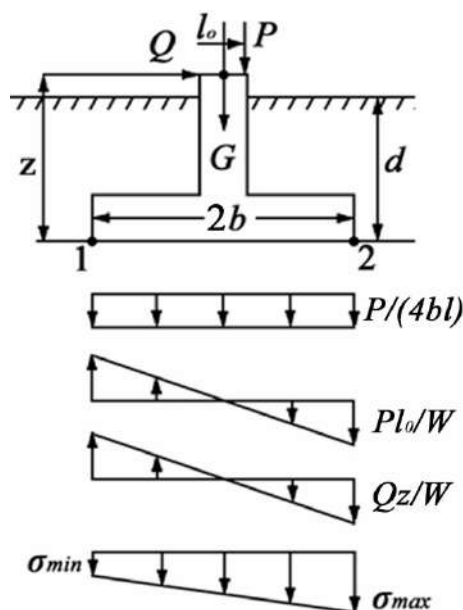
Расчетная схема распределения вертикальных напряжений в основании фундаментов от силы Р и Q
